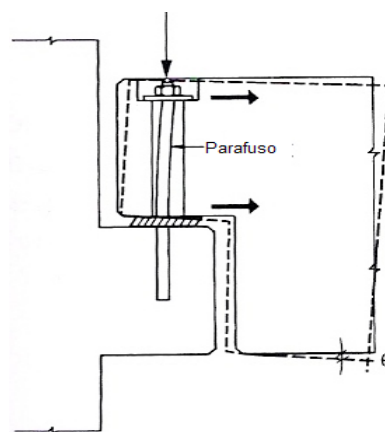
Ligação Viga – Pilar com recurso a uma consola curta (extraída de [10])
